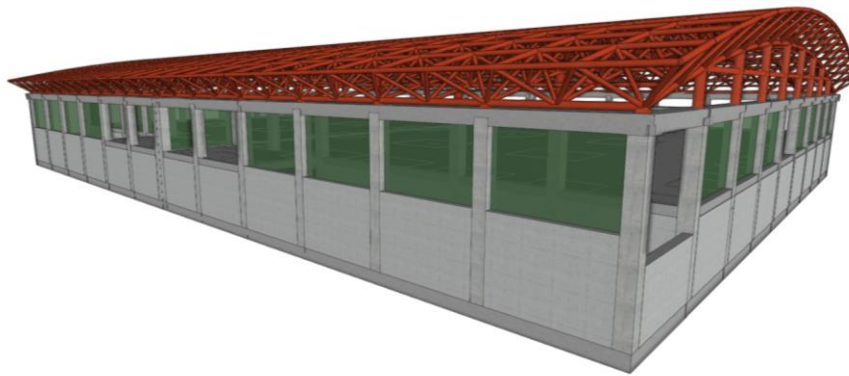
Modelo estructural con cubierta (Estereo-estructura), así como su disposición de apoyo.
